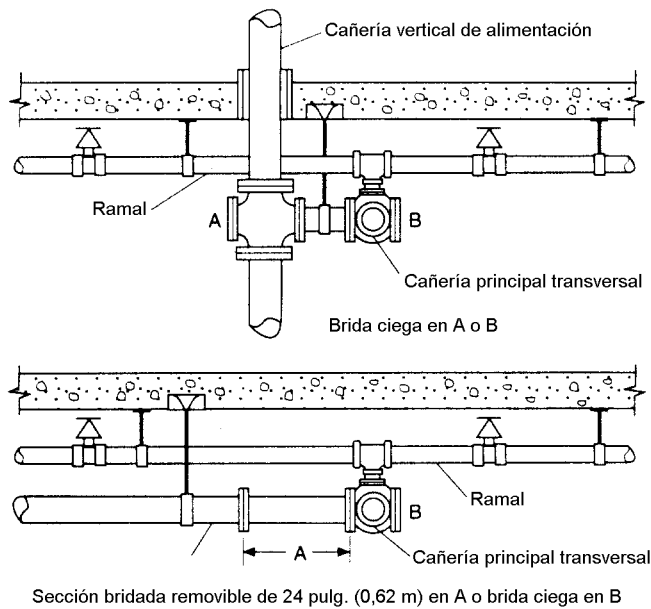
(a) Accesorios para facilitar el examen de tuberías principales de alimentación, tuberías verticales de alimentación y tuberías principales transversales, en áreas sujetas a congelamiento. Superior: corte de tubería vertical de alimentación y tubería principal transversal. Inferior: corte de tubería principal de alimentación y tubería principal transversal.
